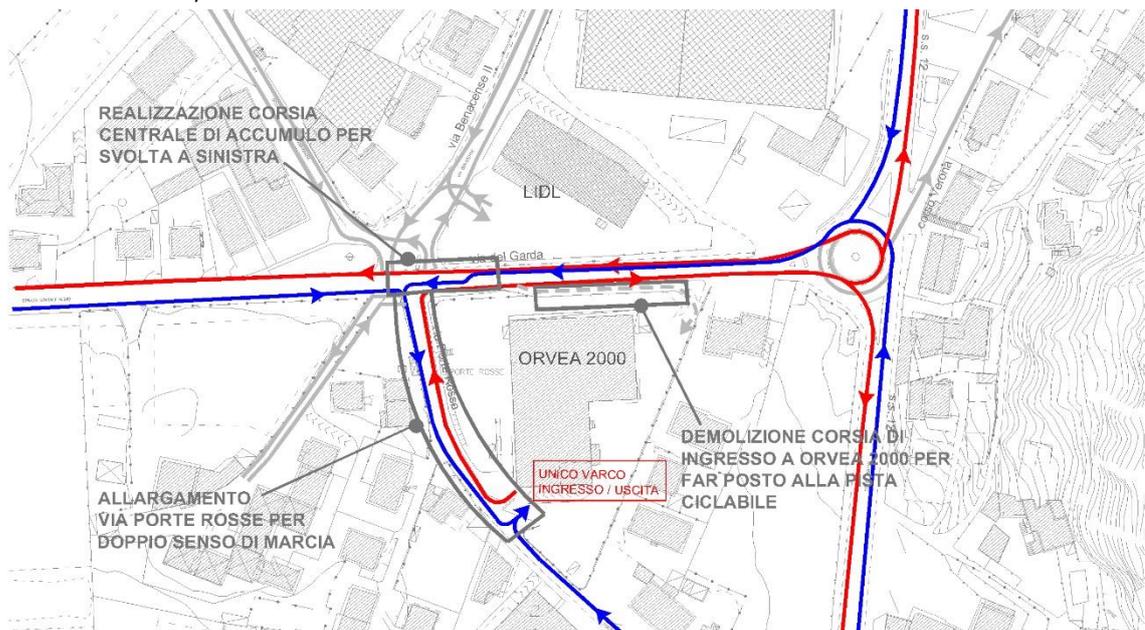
Orvea 2000, accessi e recessi dalla struttura nello scenario di progetto, SOLUZIONE A.
